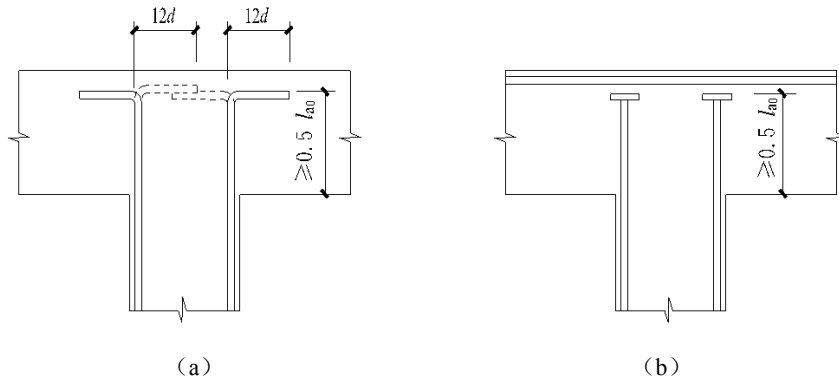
顶层节点中柱纵向钢筋在节点内的锚固
